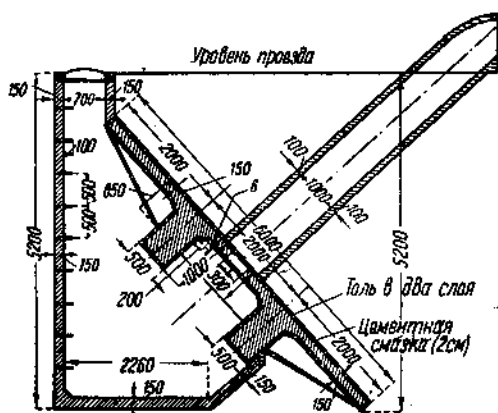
Конструкция опорного узла вантовой фермы на пилоне
